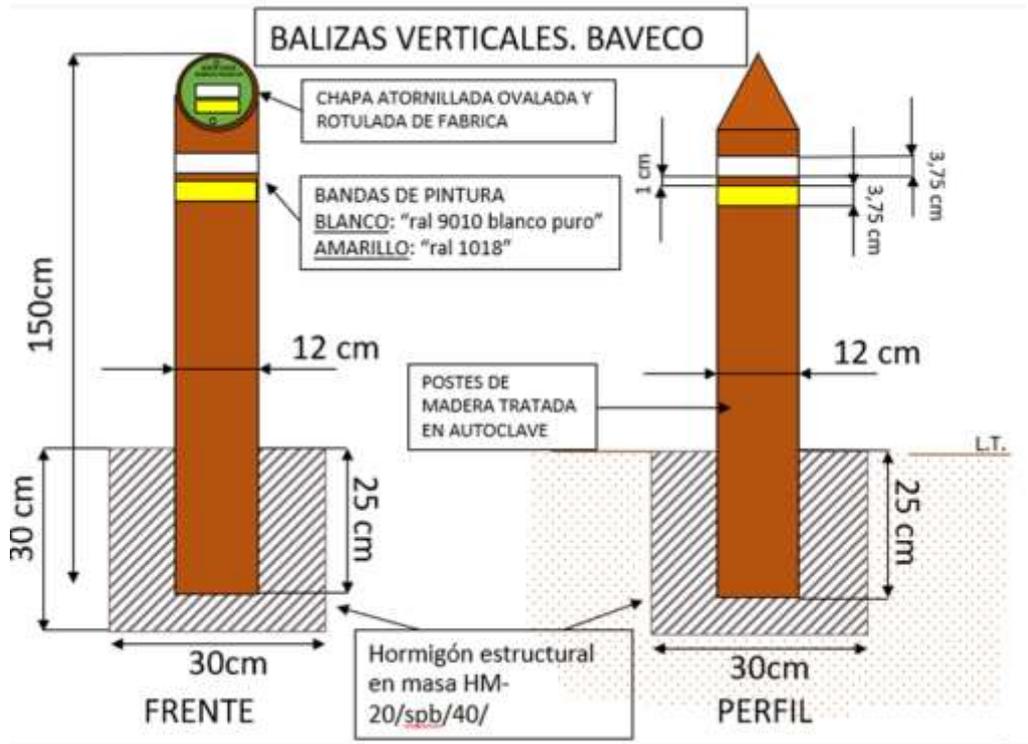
Croquis explicativo de la unidad de obra BAVECO. Fuente: Elaboración Propia
